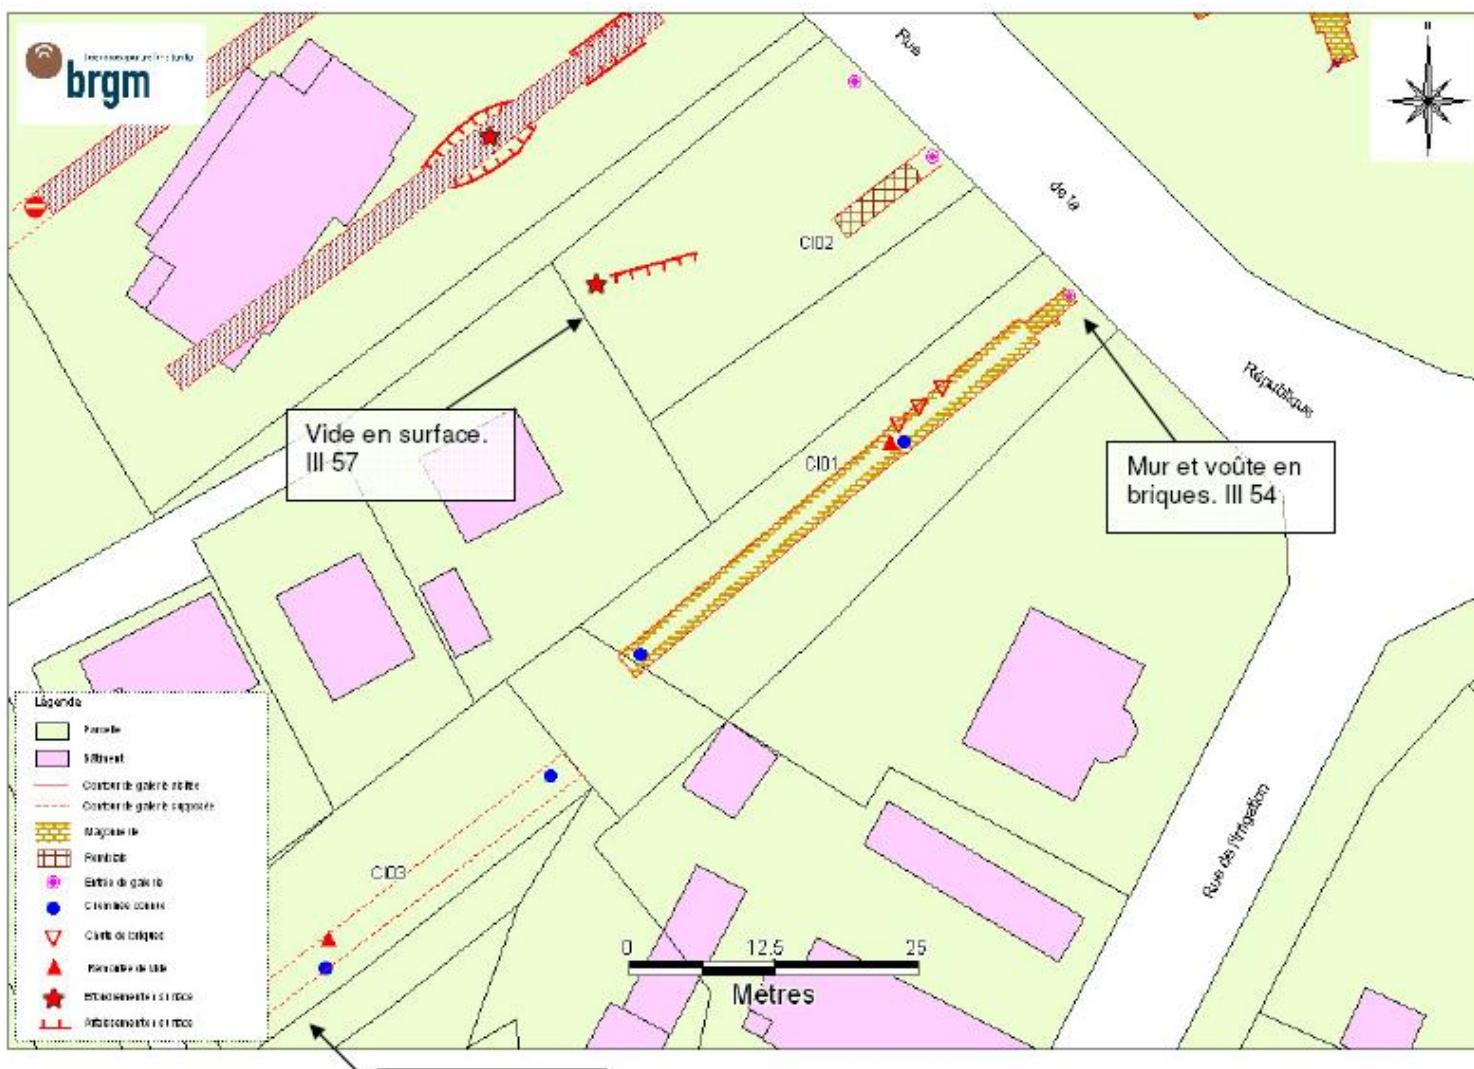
Plan de la galerie située au croisement entre la rue de la république et la rue de l'irrigation
